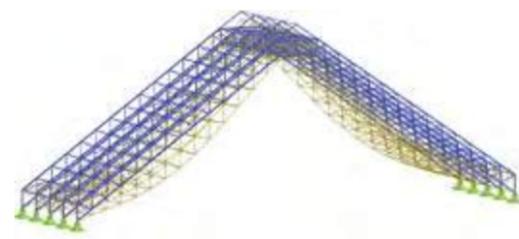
Работа конструктивного решения ЭКД-Земля в виде пирамиды, прямоугольной в плане, под нагрузкой
